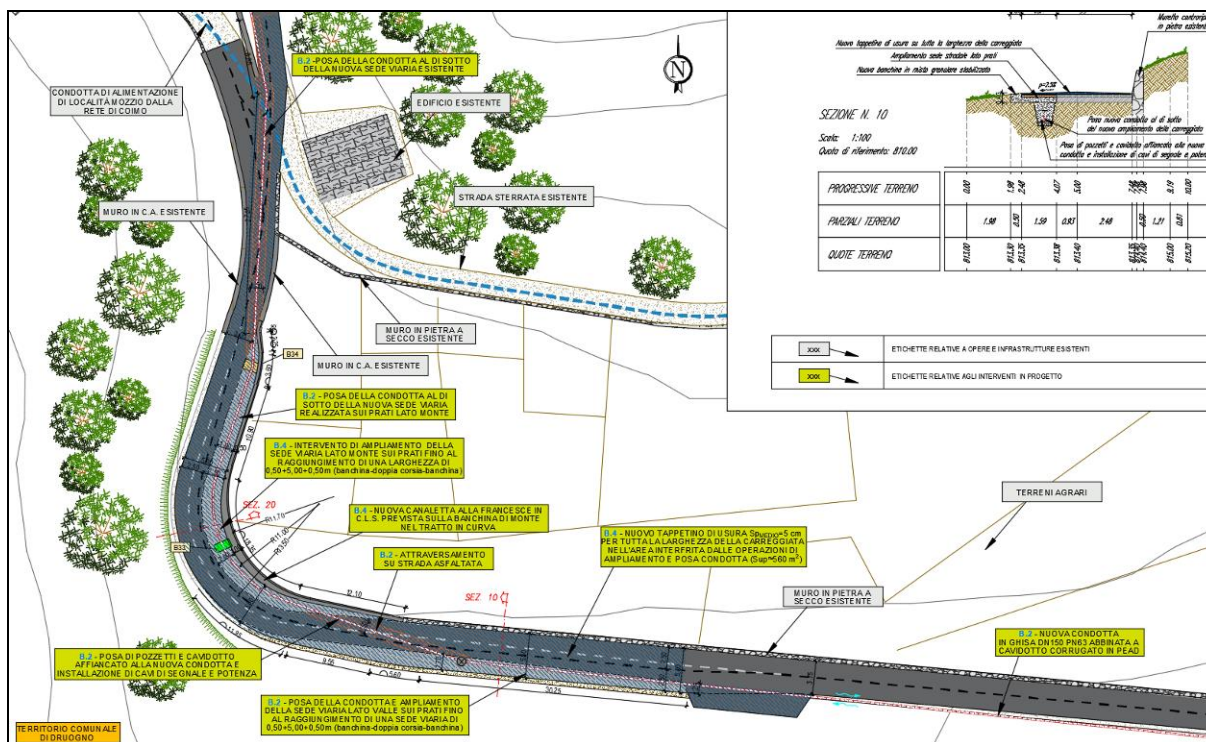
Planimetria di progetto dell'intervento di ampliamento della sede viaria di via Curti a Coimo
